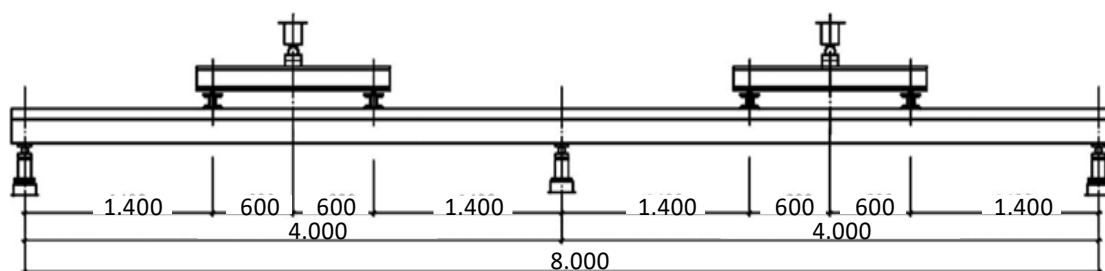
Seção longitudinal e esquema de aplicação de cargas (mm)
